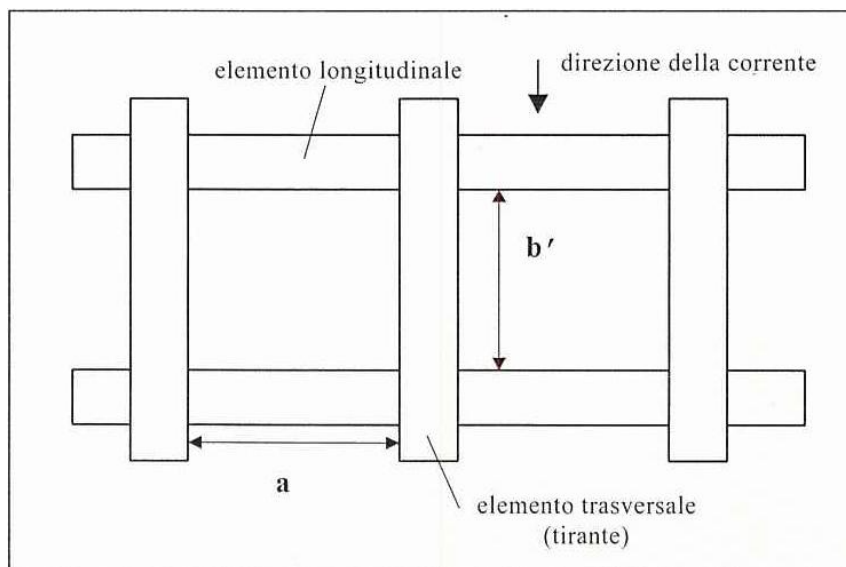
Schema della struttura a celle di un cassone (pianta).
